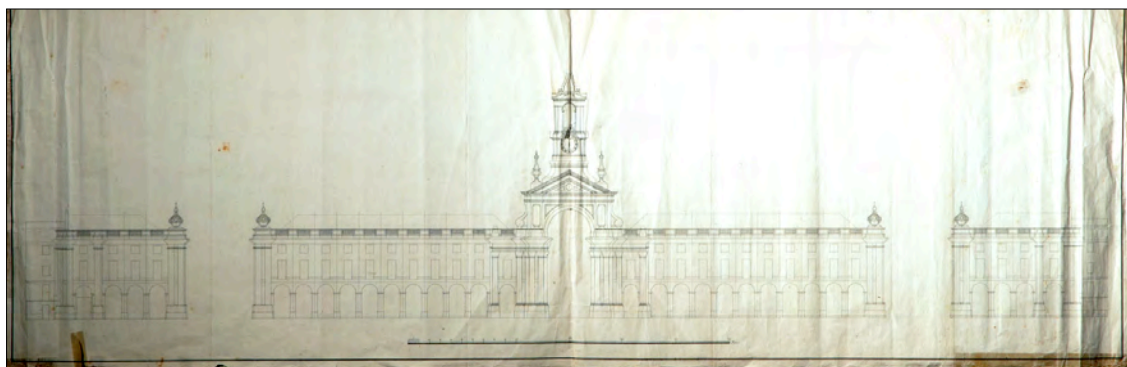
Prospetto - Praça do Comércio di Lisbona prima del terremoto.
